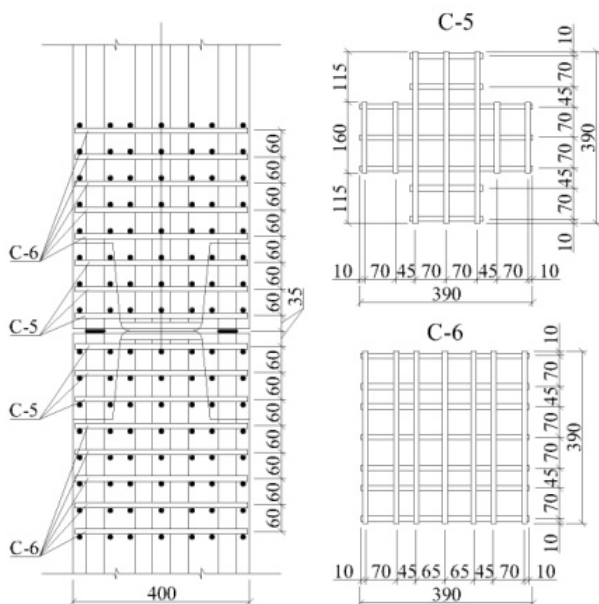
Схема расположения сеток косвенного армирования проектного стыка железобетонных колонн первого этажа
